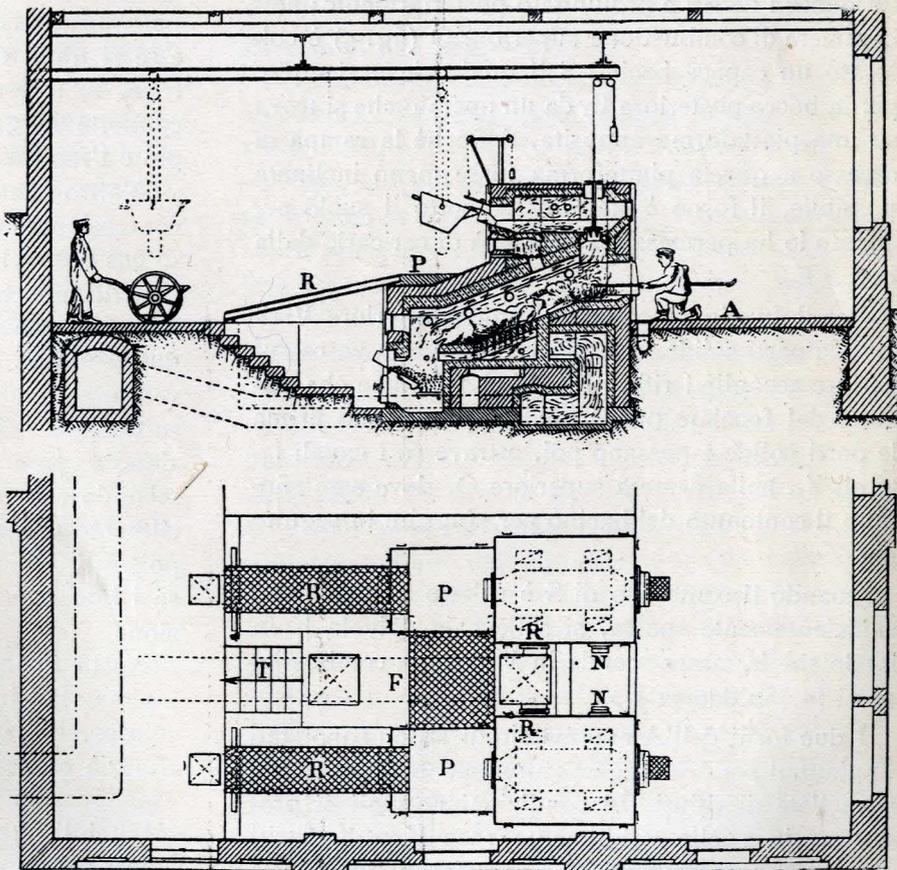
e 7. - Sezione e pianta dell'impianto per l'Amazzatoio di Essen.
